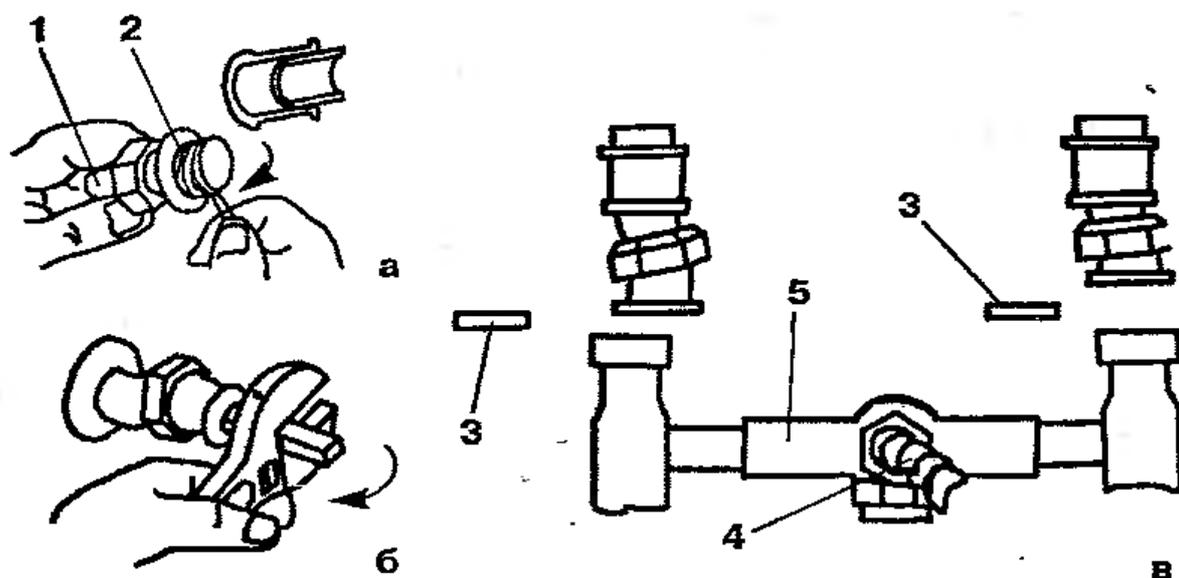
Смеситель с вертикально расположенным кнопочным переключателем и его монтаж на трубопроводах: а — наматывание нитей уплотнения на патрубок; б — заворачивание патрубка; в — подсоединение корпуса к патрубкам, заворачиваемым постепенно в муфты трубопроводов; 1 — патрубок; 2 — декоративная шайба; 3 — уплотнительное резиновое кольцо; 4 — гибкий шланг; 5 — основание
